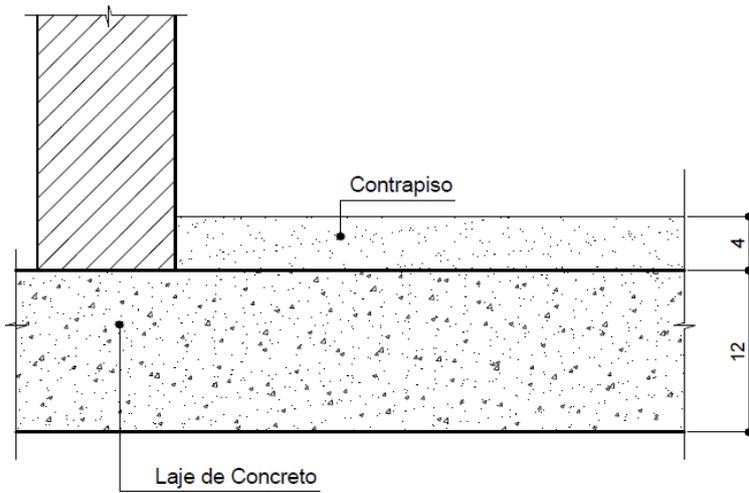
Sistema de piso (Laje de 12 cm e contrapiso de 4,0 cm)
